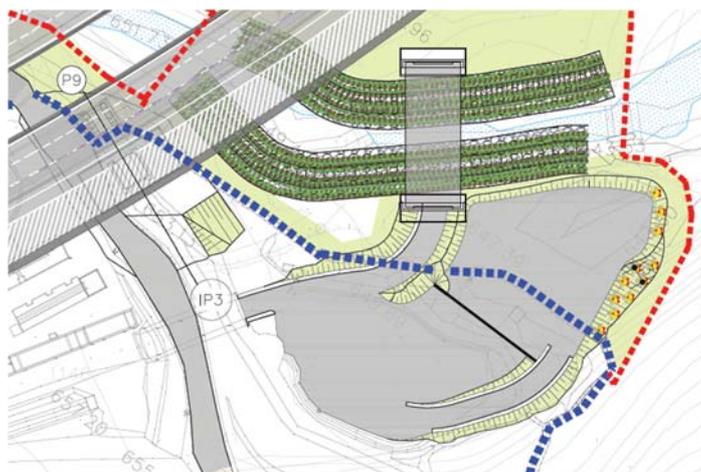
Stralcio planimetrico del piezometro SVI AST 1.0 – la freccia blu indica la localizzazione
